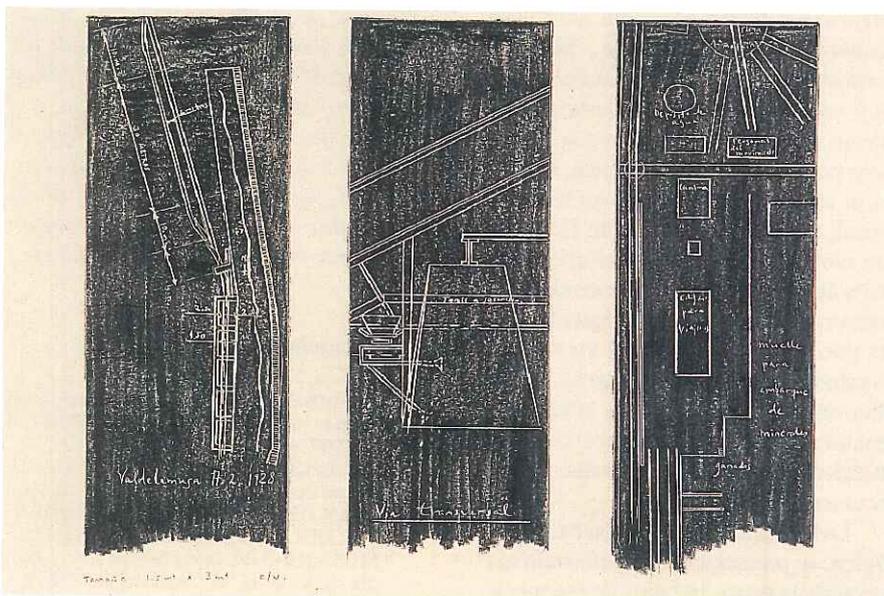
Representación grabada de fragmentos de plantas y alzados de la estructura, obtenidos de los planos originales del cargadero, sobre tres planchas de acero de 300 x 150 x 1 cm.
